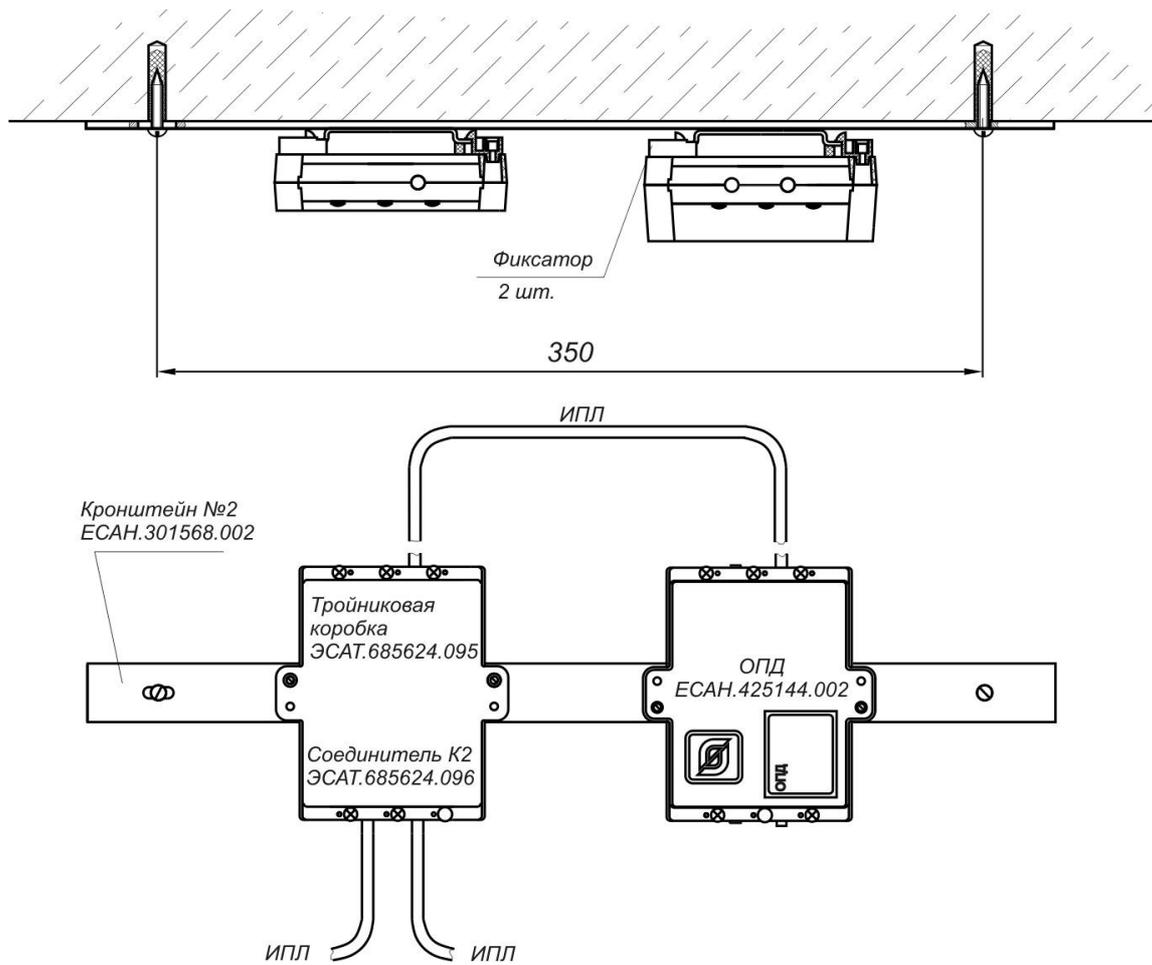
Установка ОПД и тройниковой коробки на кронштейн №2
